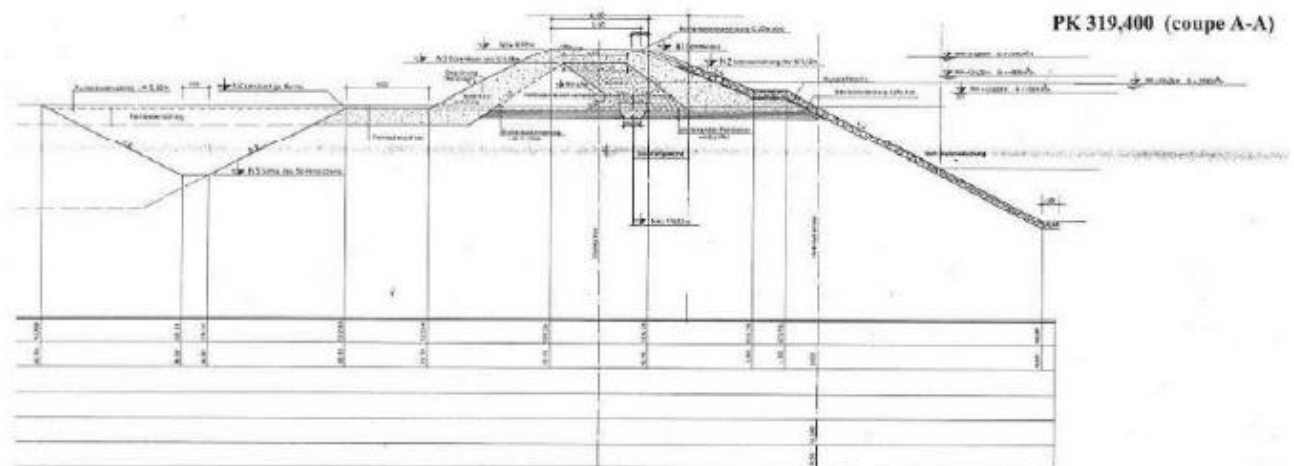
Coupe-type du barrage latéral au PK 319,400
